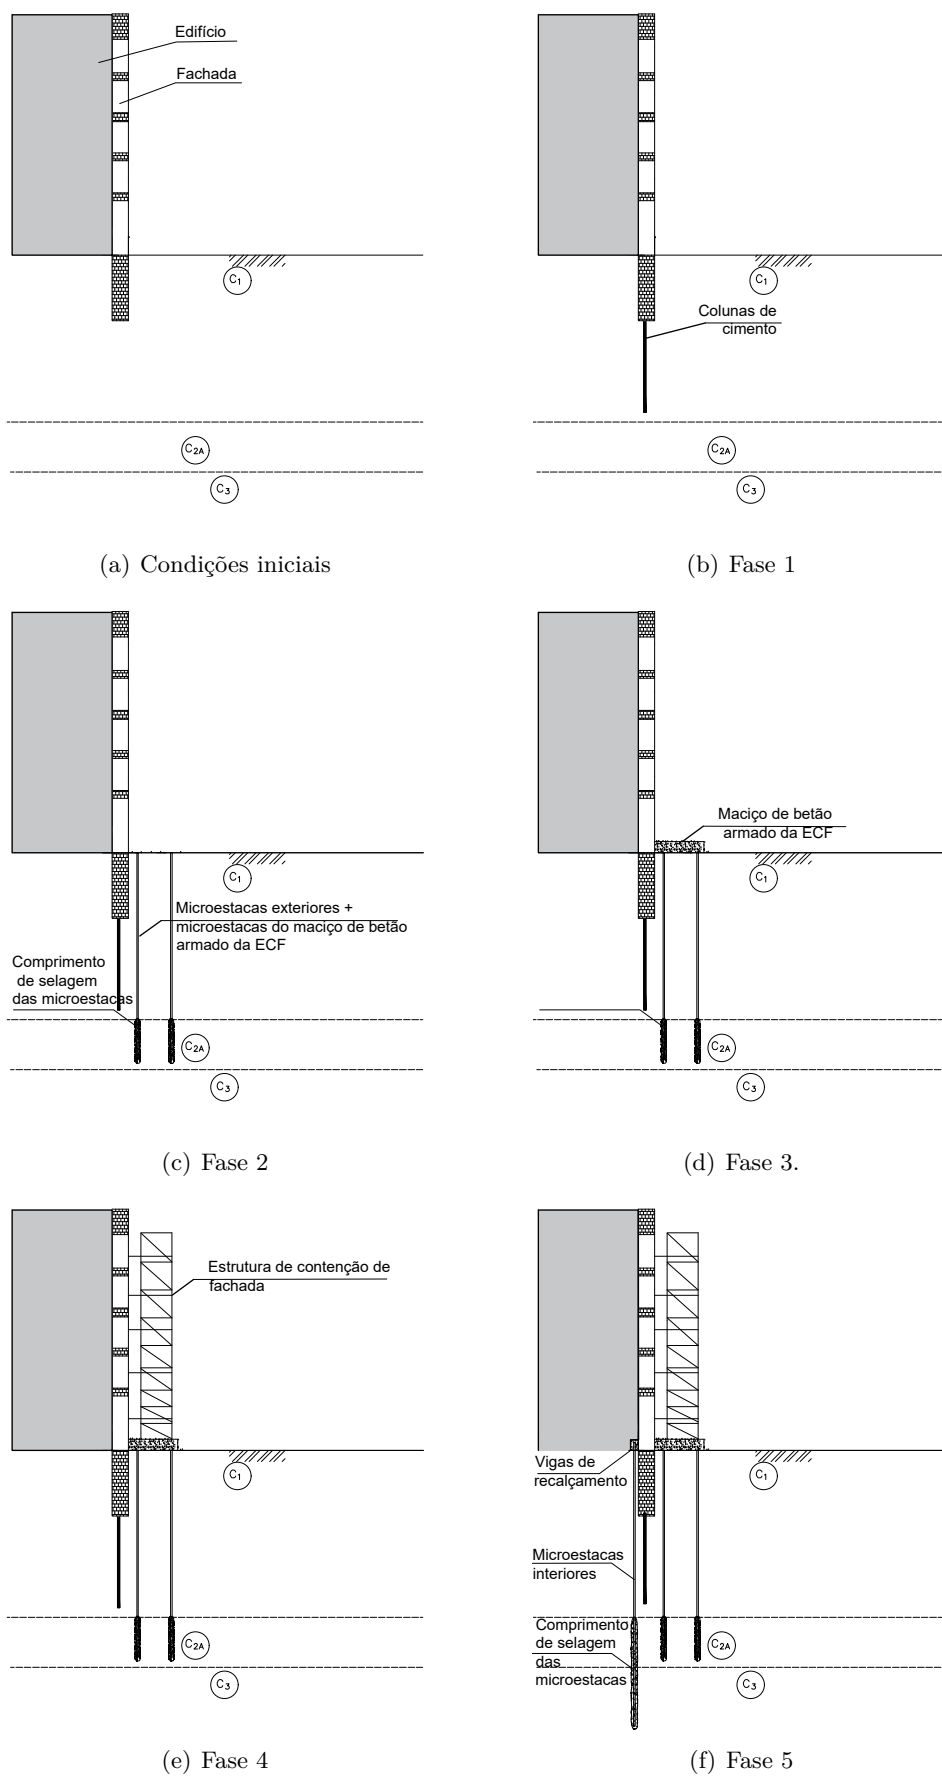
Faseamento construtivo - Cenários C4 e C6
